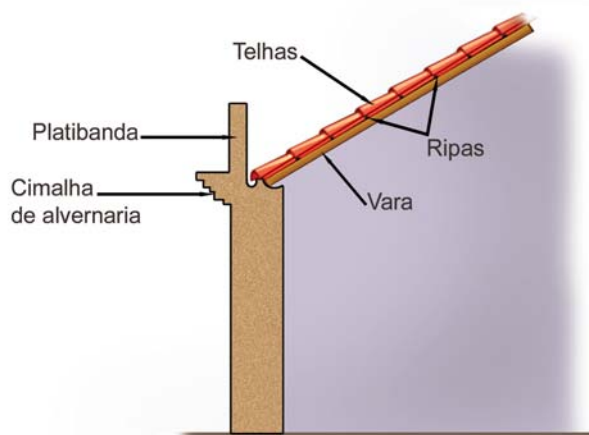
Coroamento de uma parede de fachada com platibanda.
